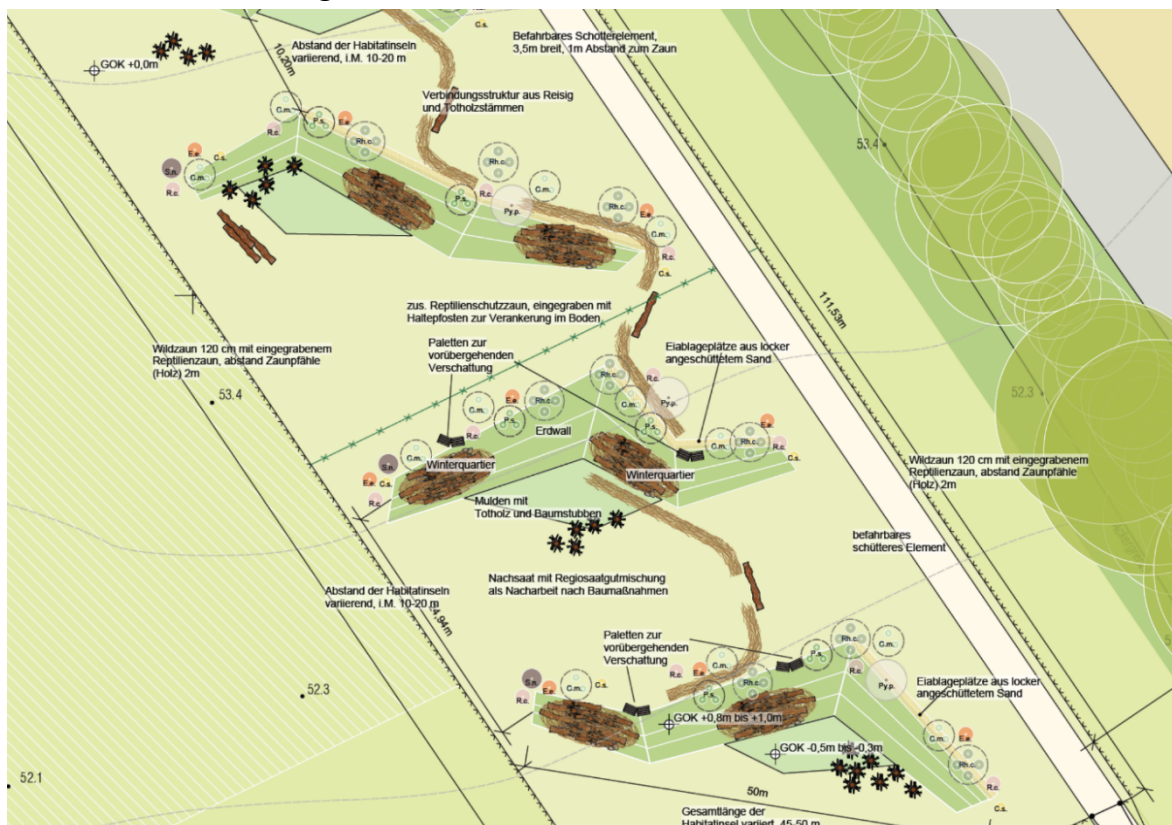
Ausschnitt Ersatzhabitat Zauneidechsen. Ausführungsplanung Anlage 1. Ausschnitt Lageplan. bgmr Landschaftsarchitekten
